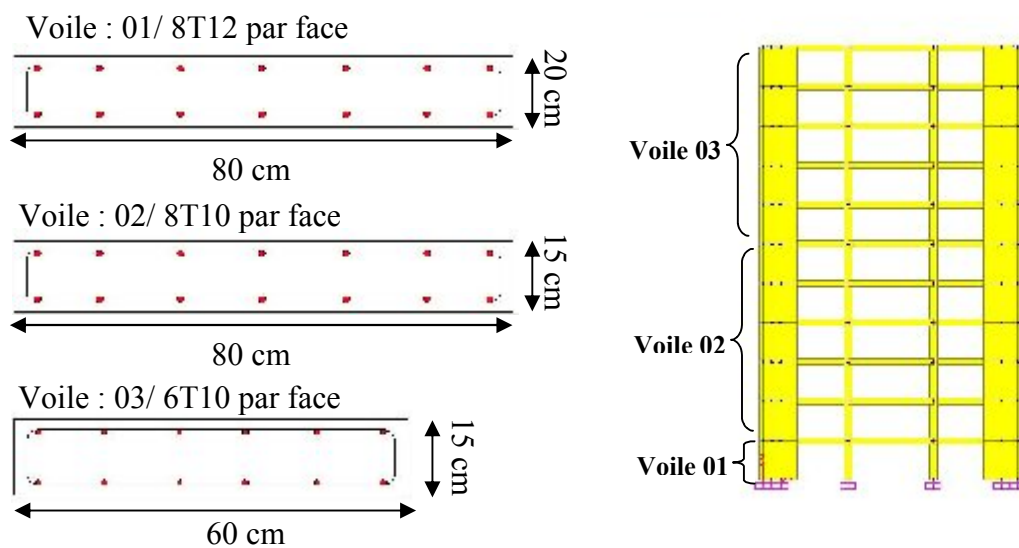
Sections et distribution des voiles selon la hauteur du bâtiment
